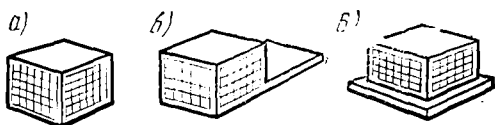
Примеры объемно-планировочных решений многоэтажных зданий:
